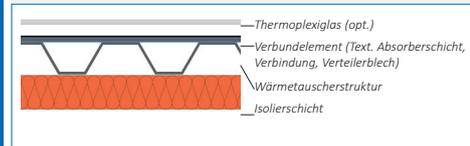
Aufbau textiler Wärmeabsorber mit Wärmetauscherstruktur
